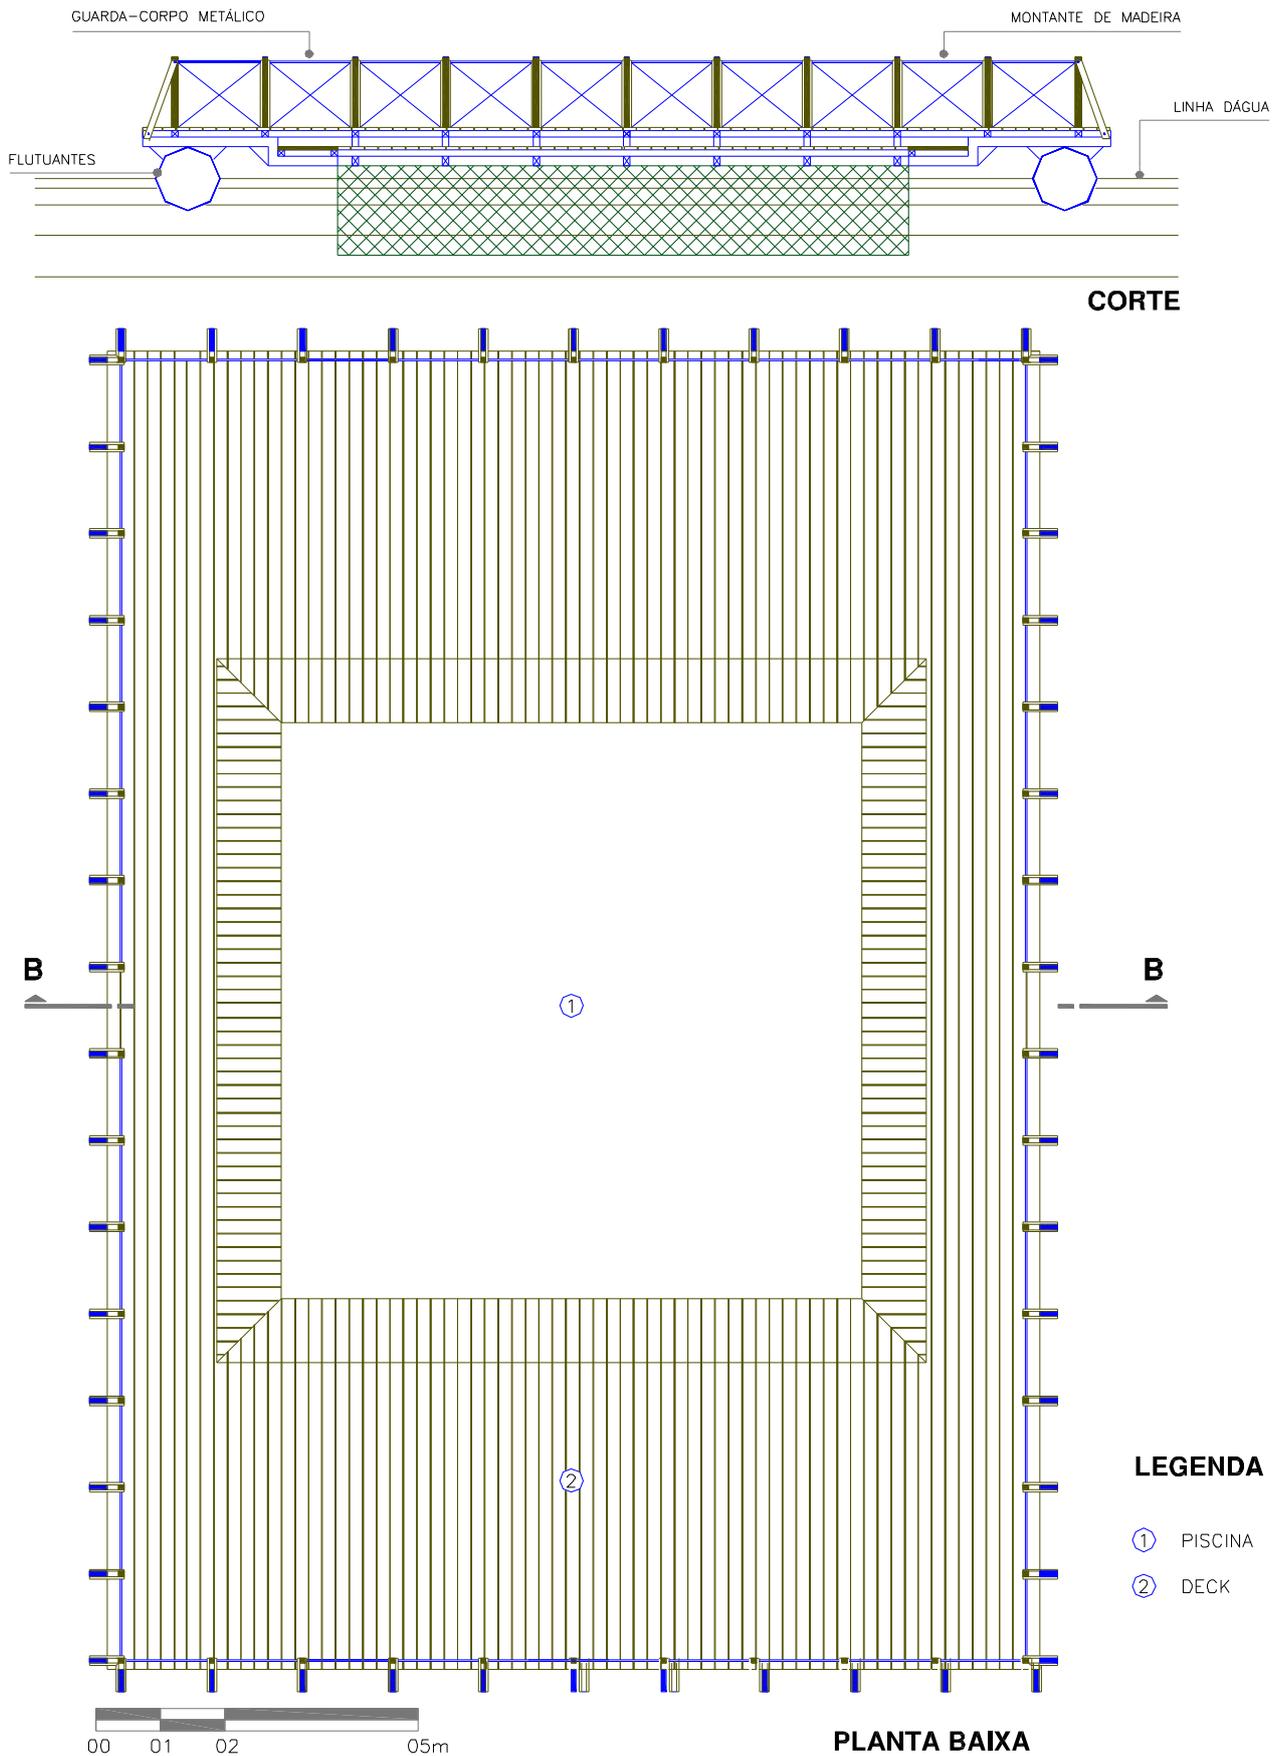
PLATAFORMA FLUTUANTE: PISCINA (CORTE E PLANTA BAIXA)
